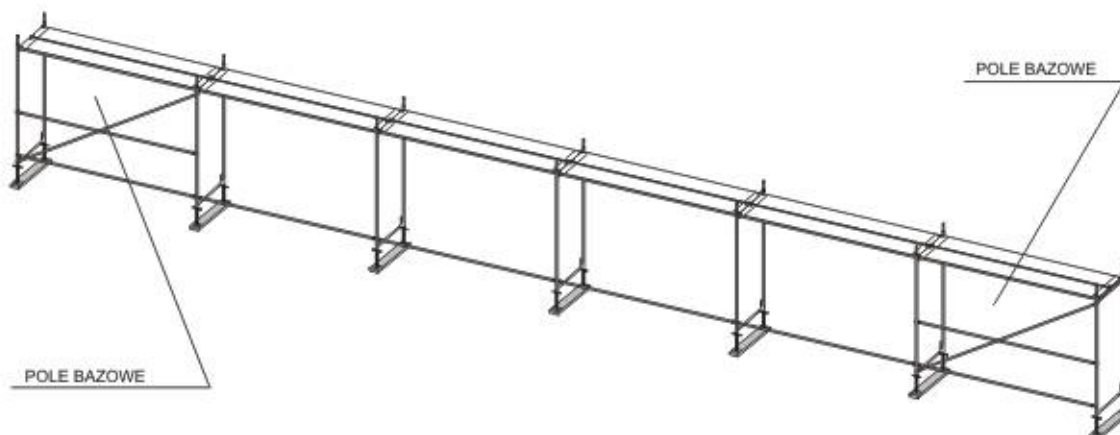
Zmontowane pole bazowe pierwszej kondygnacji
